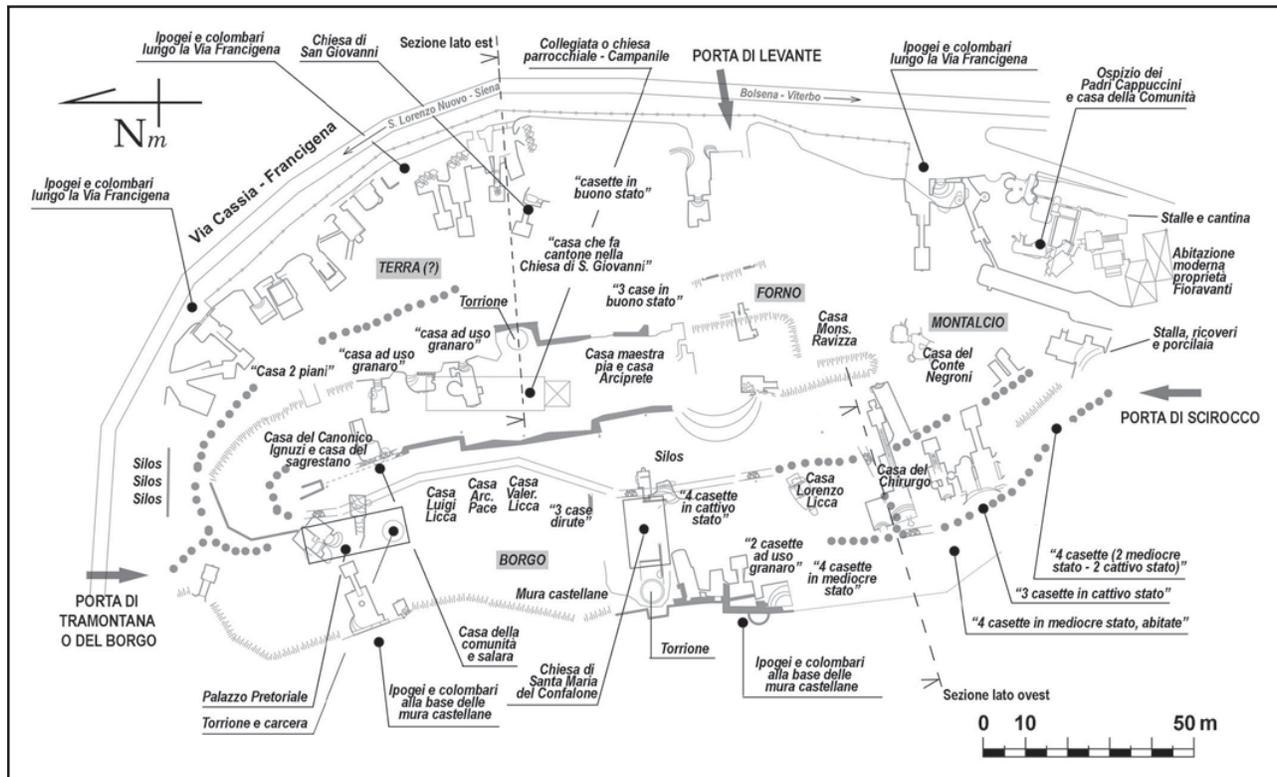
Planimetria generale dell'insediamento (Copyright CRSE).
